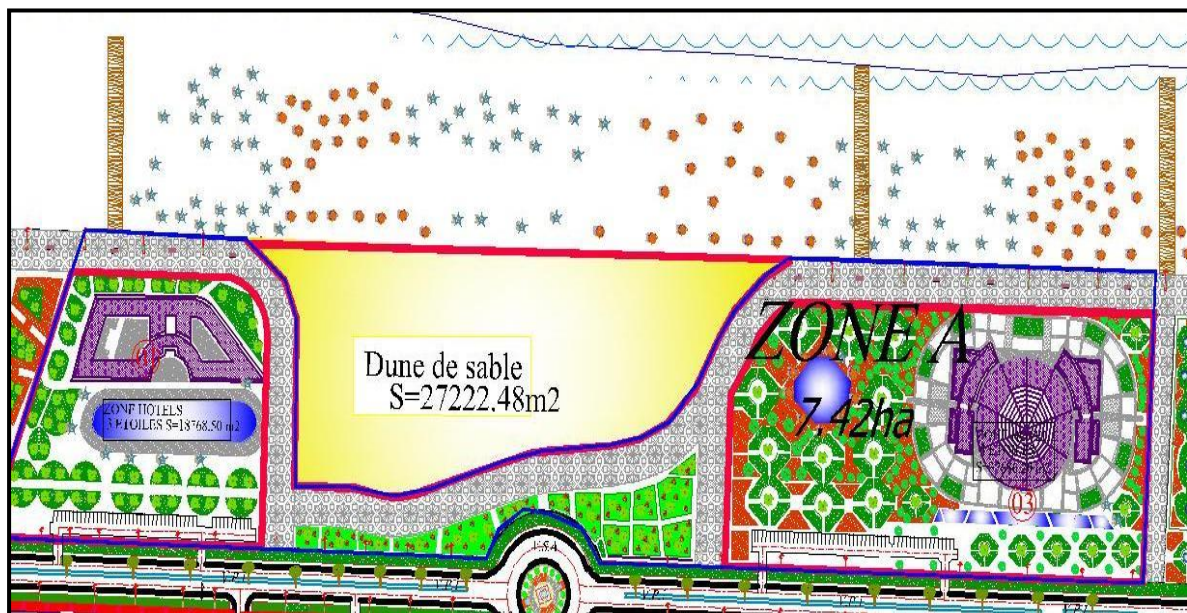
Le plan d'aménagement de la zone A dans la ZET de BENI BELAID
